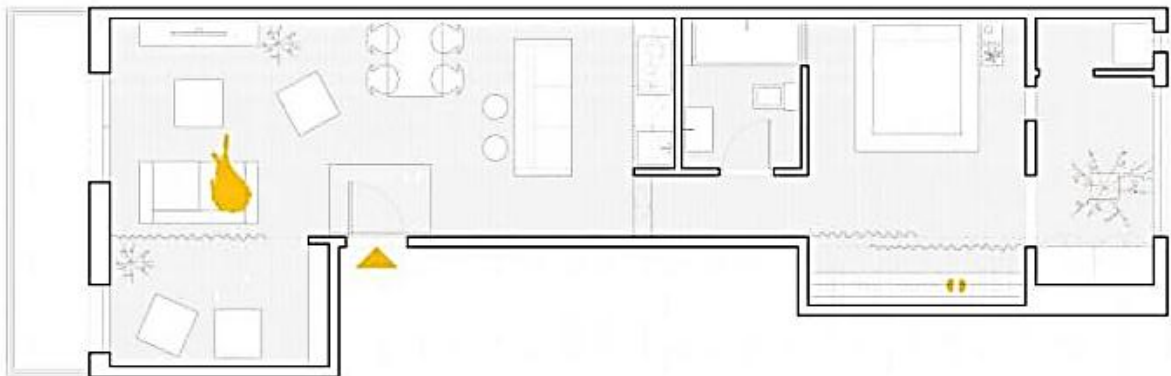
Planta, Reabilitação de Apartamento em Les Corts, Espanha.
